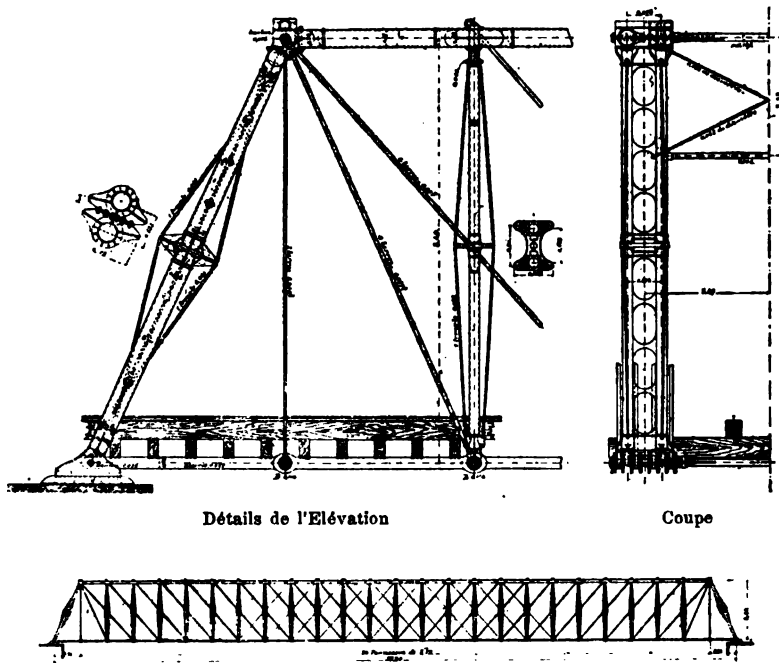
à 77. — Pont de Steubenville, sur l'Ohio.
